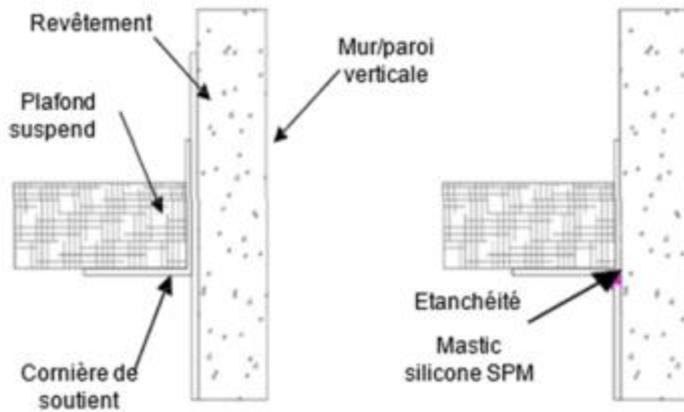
Finition au-dessus du niveau du plafond suspendu
